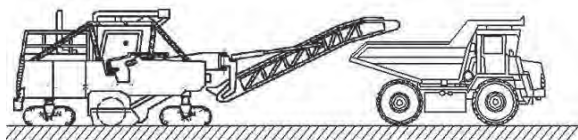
Схема погрузки фрезерного комбайна в автосамосвал
